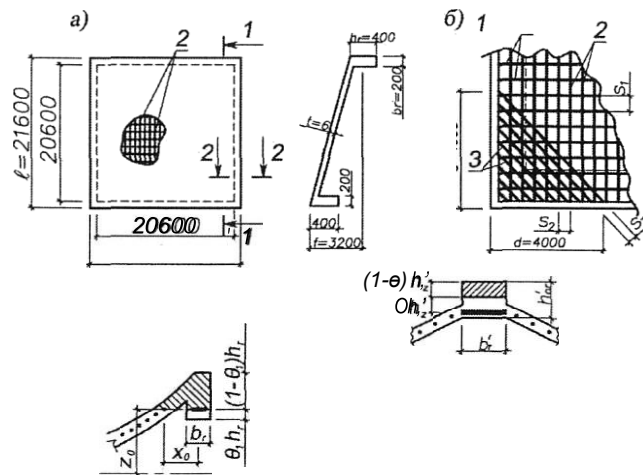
Схема армирования гипара: а - общий вид, б - армирование нижнего угла, в — примыкание оболочки к бортовому ребру, г — то же, к коньковому ребру; 1 - арматура ребра, 2 — арматура поля оболочки, 3 — арматура угловой зоны
